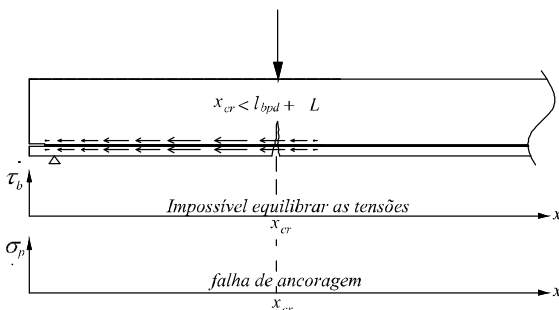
Perda de ancoragem devido à fissuração
